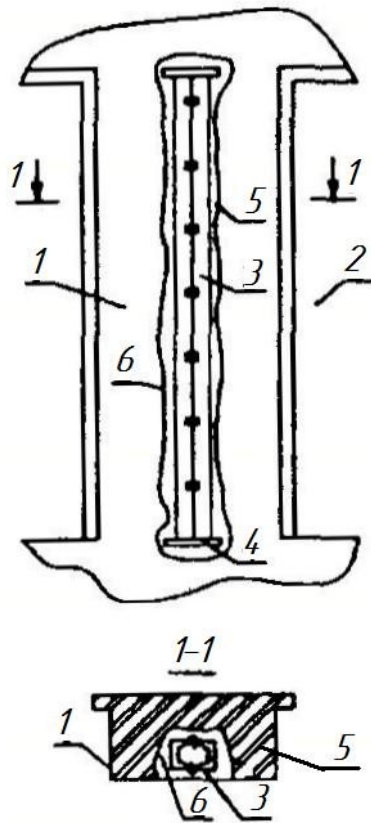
Улаштування сердечника з металевих профілів: 1 – посилюваний простінок; 2 – прорізи; 3 – стояк (сердечник) з металевих профілів; 4 – металеві пластини; 5 – ніша, вирубана в простінку; 6 – порожнеча, закарбована розчином
